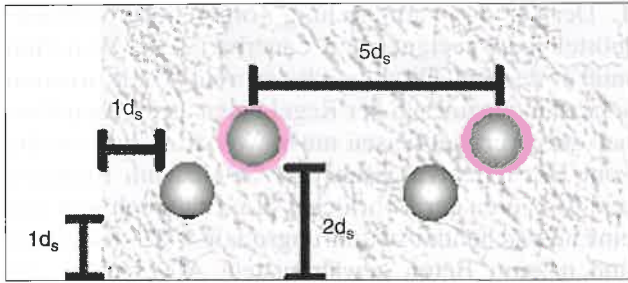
Minimale Betondeckung und minimaler Achsabstand für eingemörtelte Bewehrungsstäbe bei Erstellung des Bohrlochs mit einer elektrischen Hammerbohrmaschine
